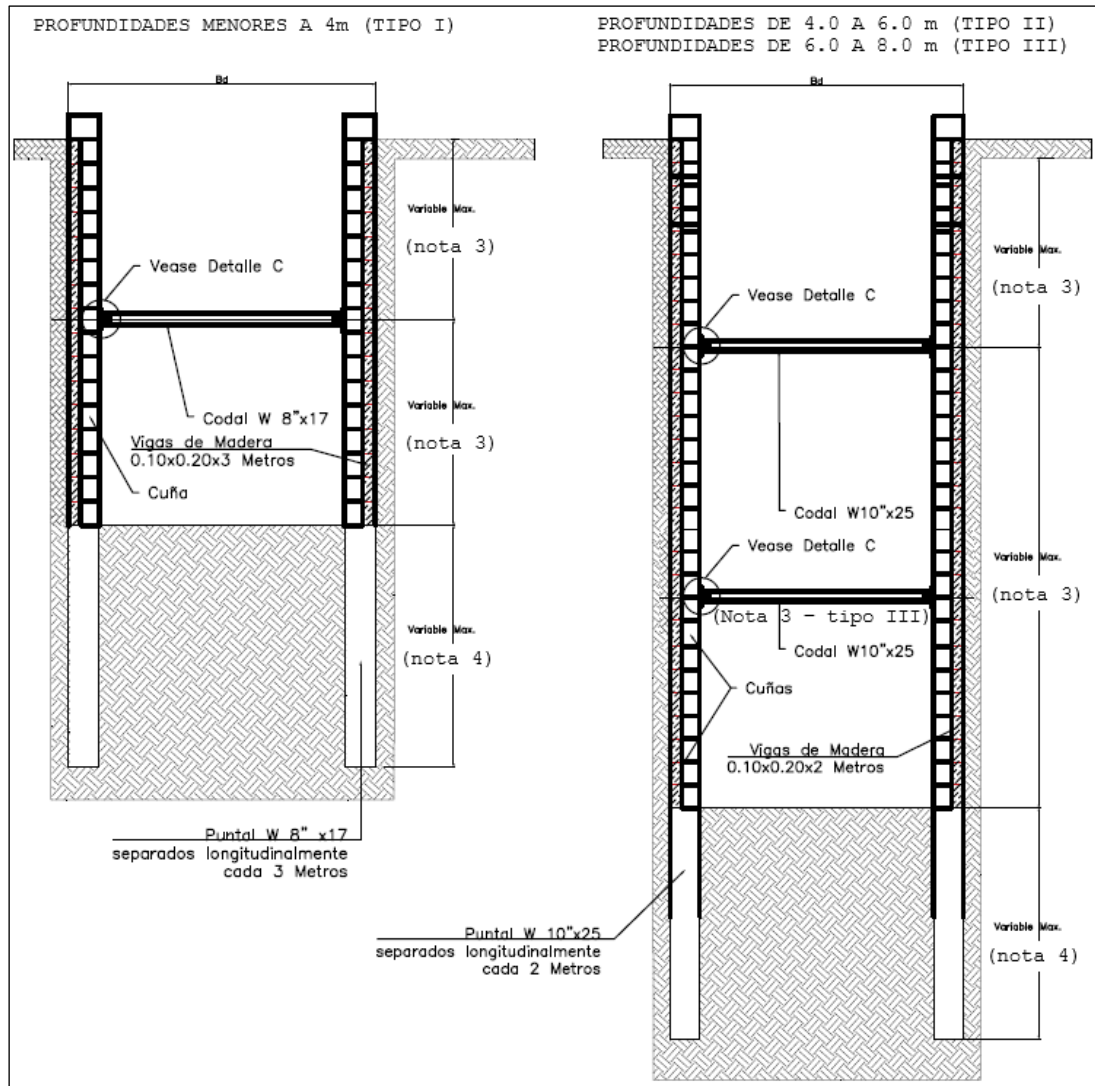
Esquema de entibado Mixto de madera – perfiles metálicos - Modificado de NS-072 de EAAB.
